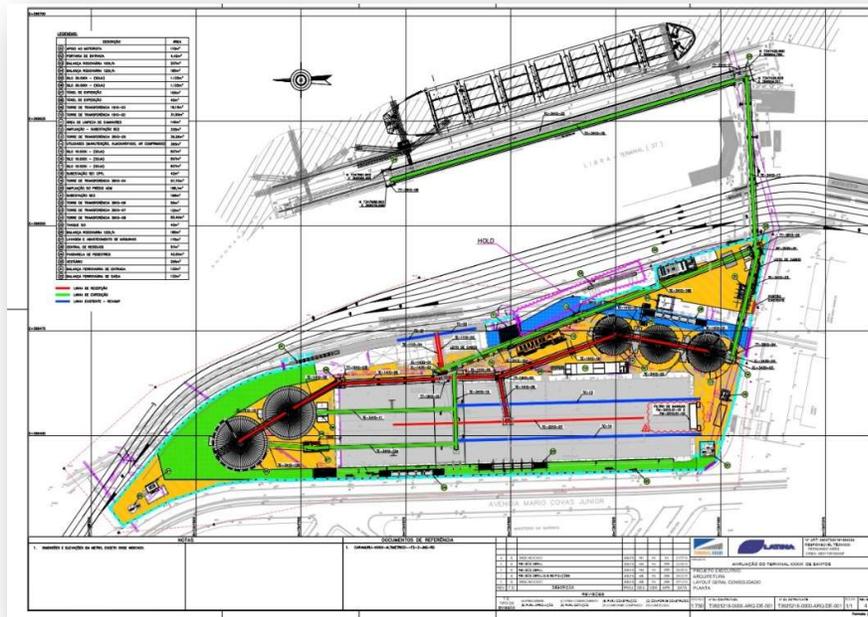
Planta Arquitetônica do Terminal XXXIX
